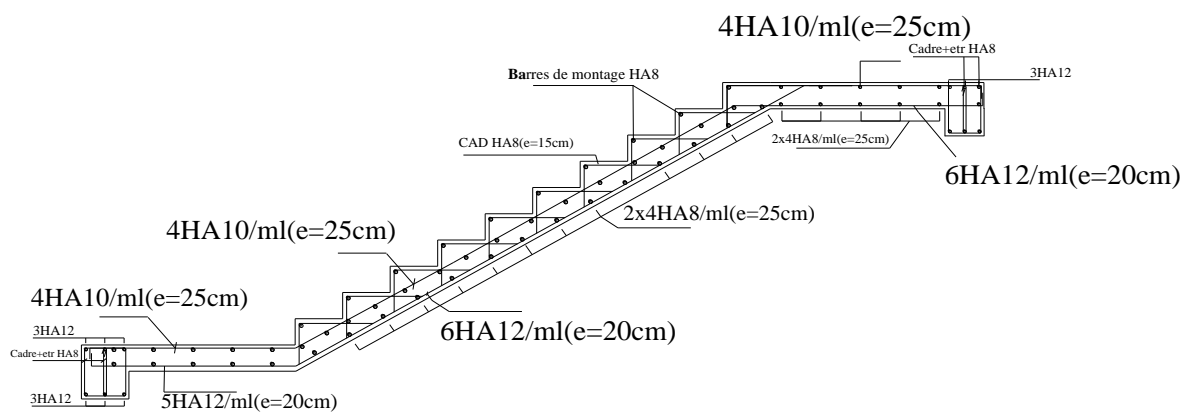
Schéma de ferrailage des escaliers étage courant.
